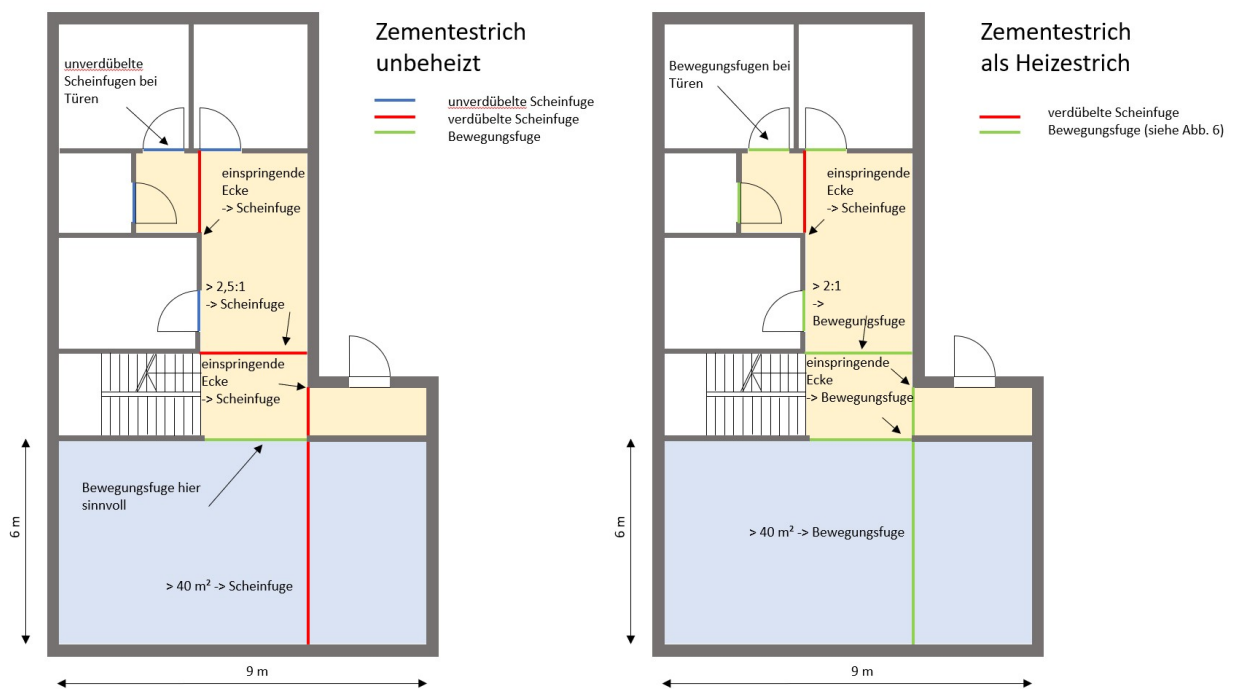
Grundriss Wohneschoß mit Zementestrich (beheizt und unbeheizt)
